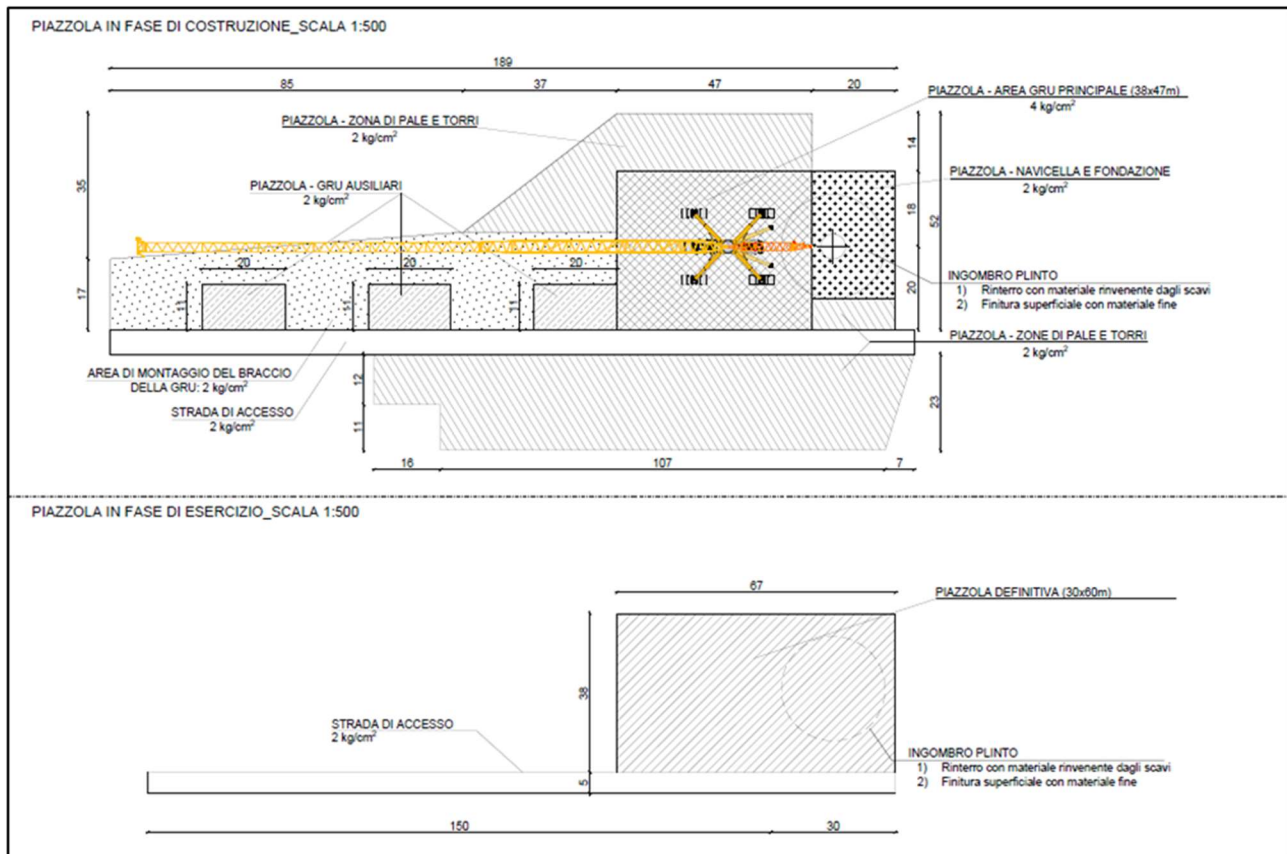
Planimetria piazzola tipo per la fase di installazione e fase di esercizio e manutenzione
